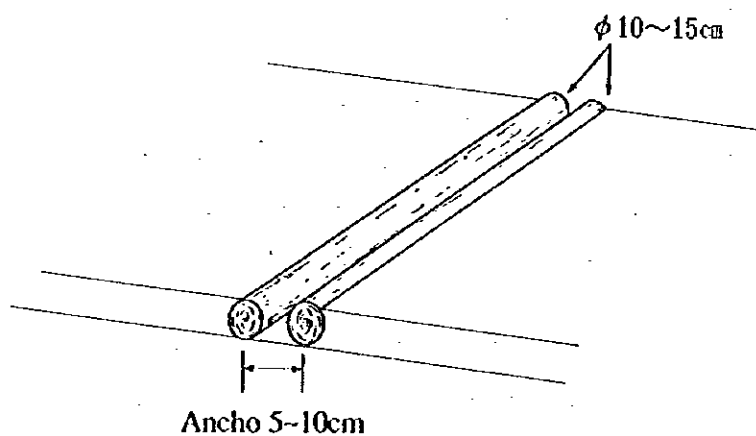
Canal Sencillo Transversal Formado con Maderas en Rollo
